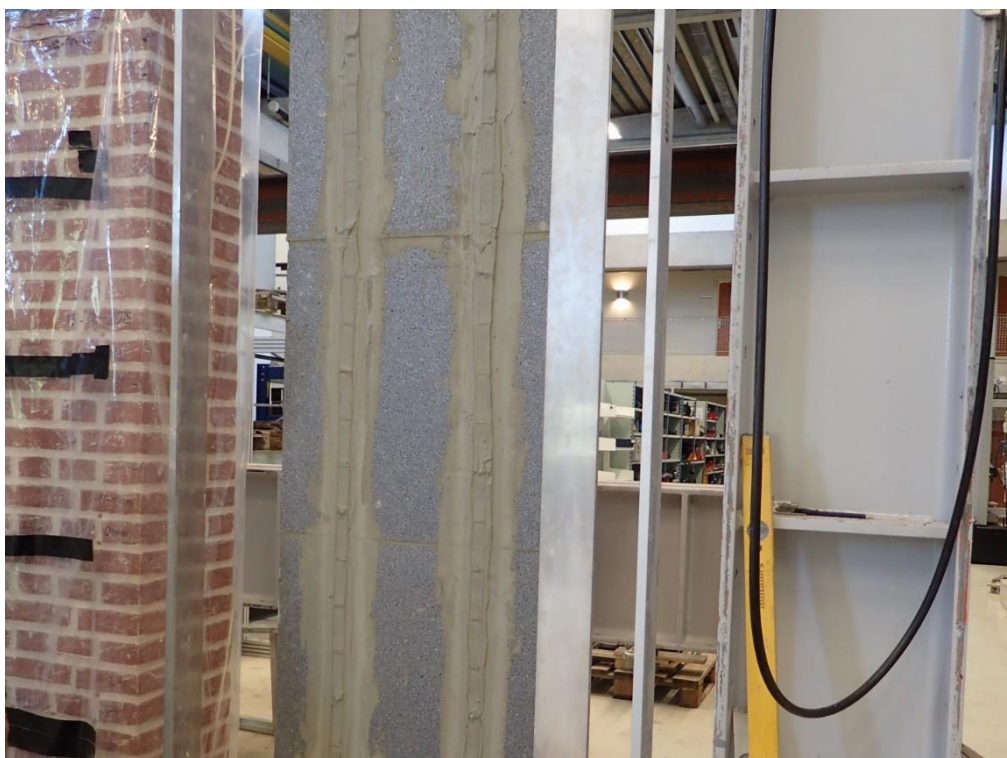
Efter alle EPS-pladerne er limet op, limes igen to kolonner af Murtec Dista oven på EPS'en.
